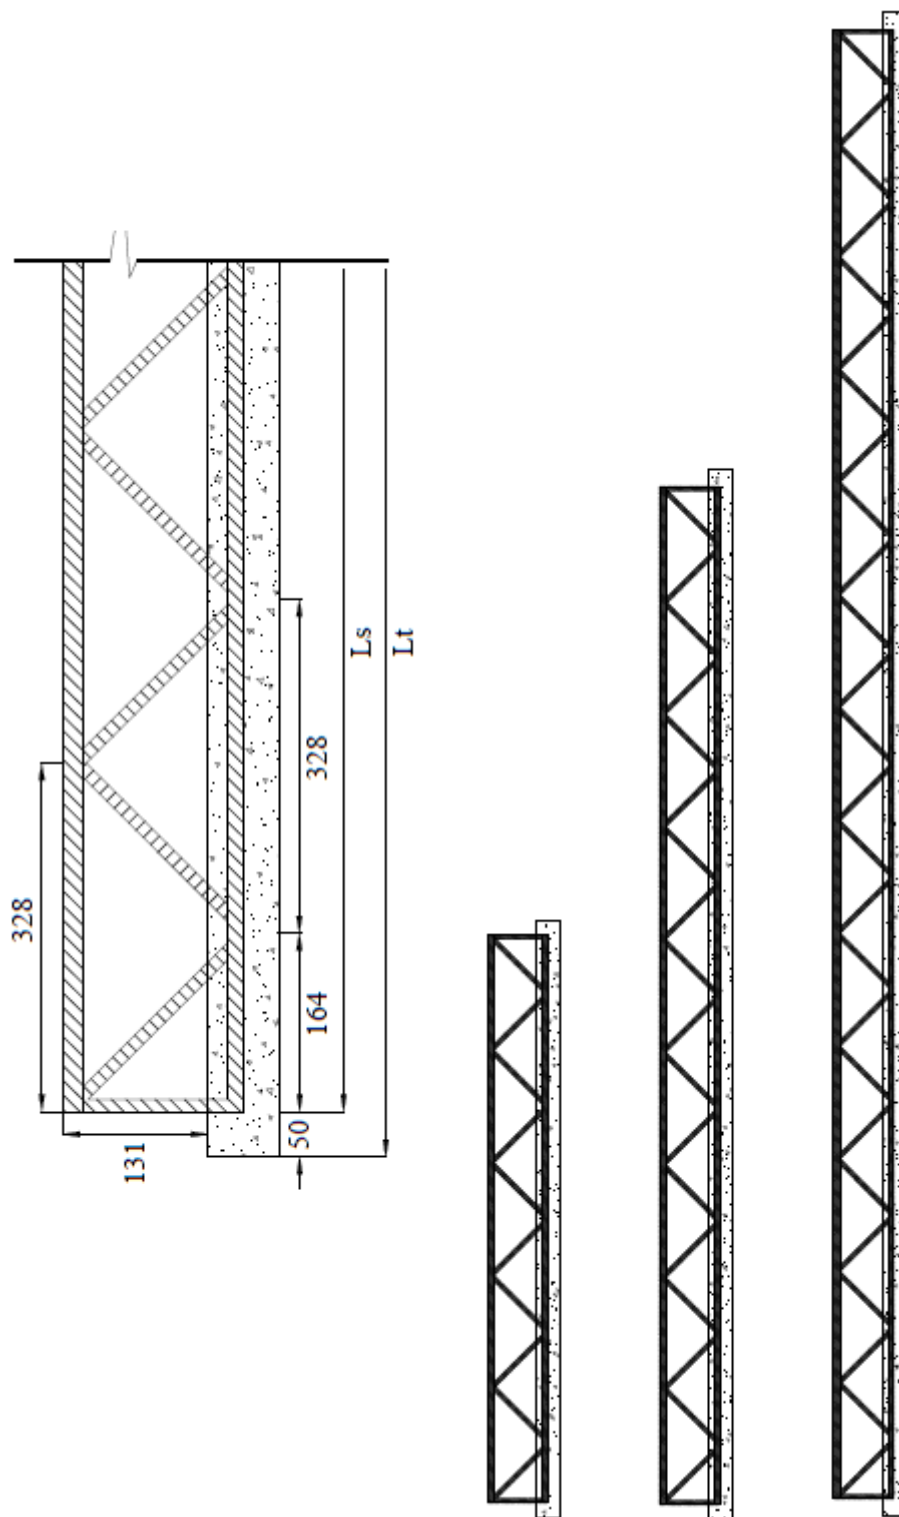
Secciones Longitudinales fase SI, tipo B
